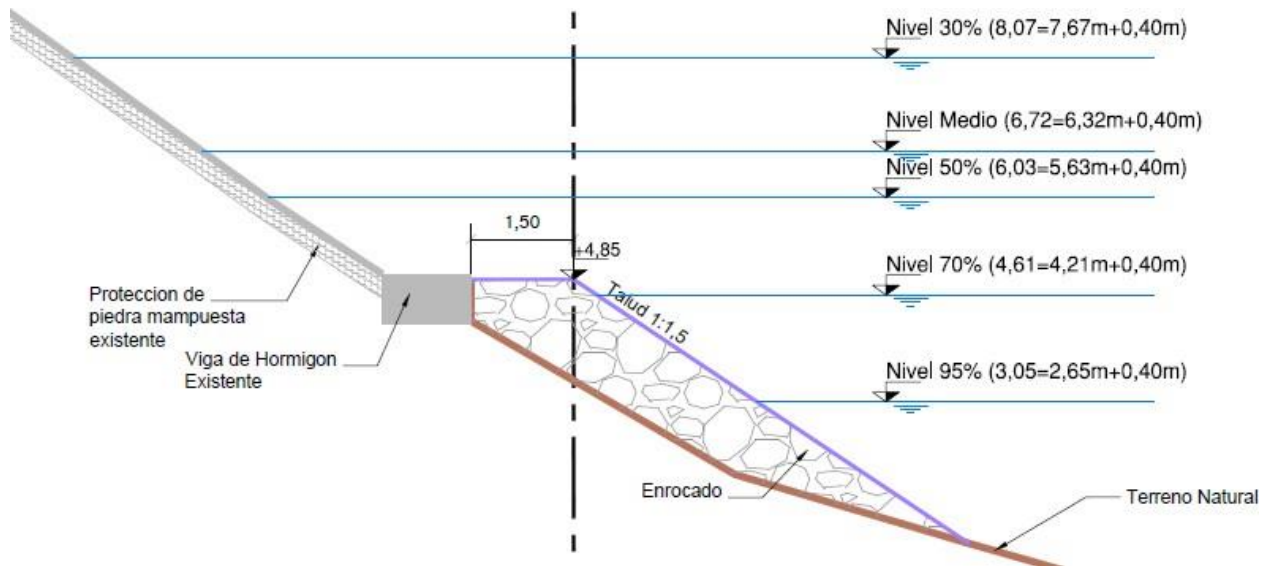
Perfil Tipo 1. Protección con enrocado de la defensa existente entre Pr. 0 a 45m.
